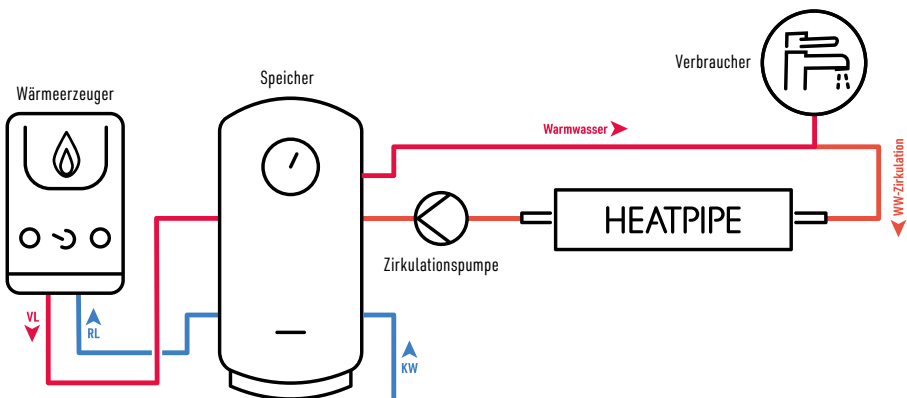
Beispiel-Schema | Einbau in Warmwasser-Zirkulationsleitung
